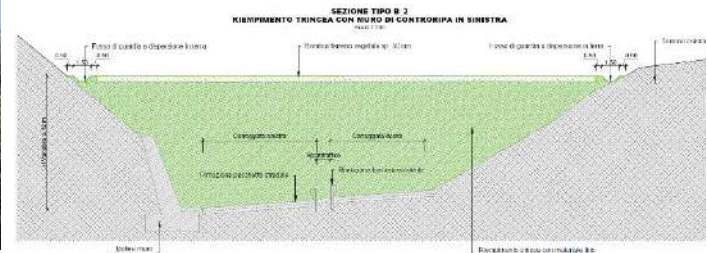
Sezione tipo B_2 riempimento trincea con muro in sinistra
